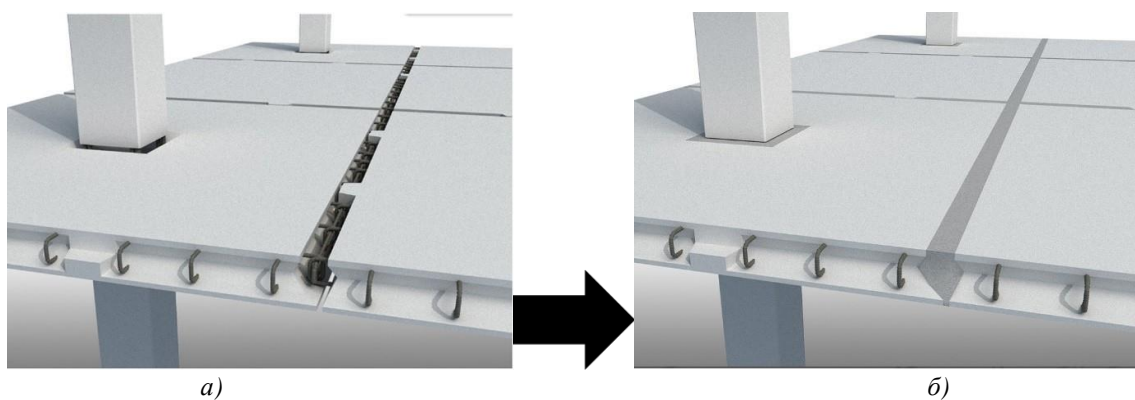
Узел сопряжения железобетонных плит перекрытия:
